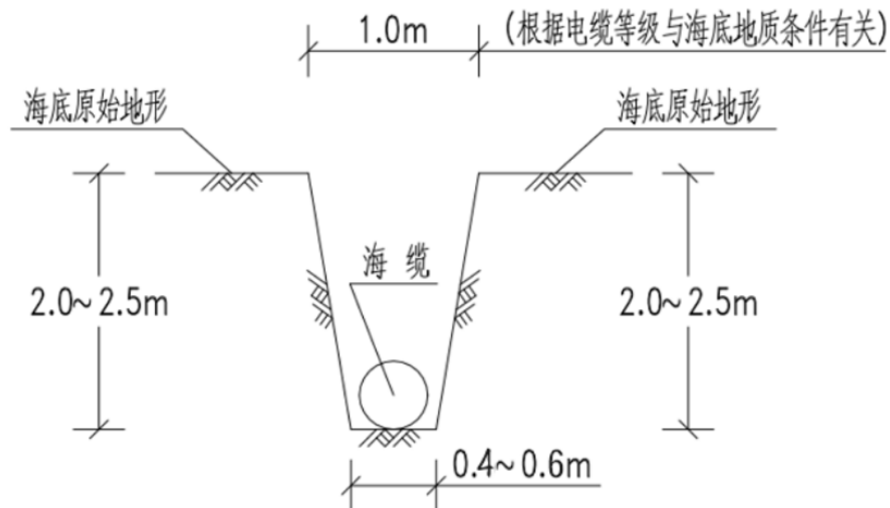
浅水与滩涂区域（水深<3m）开挖施工断面示意图
